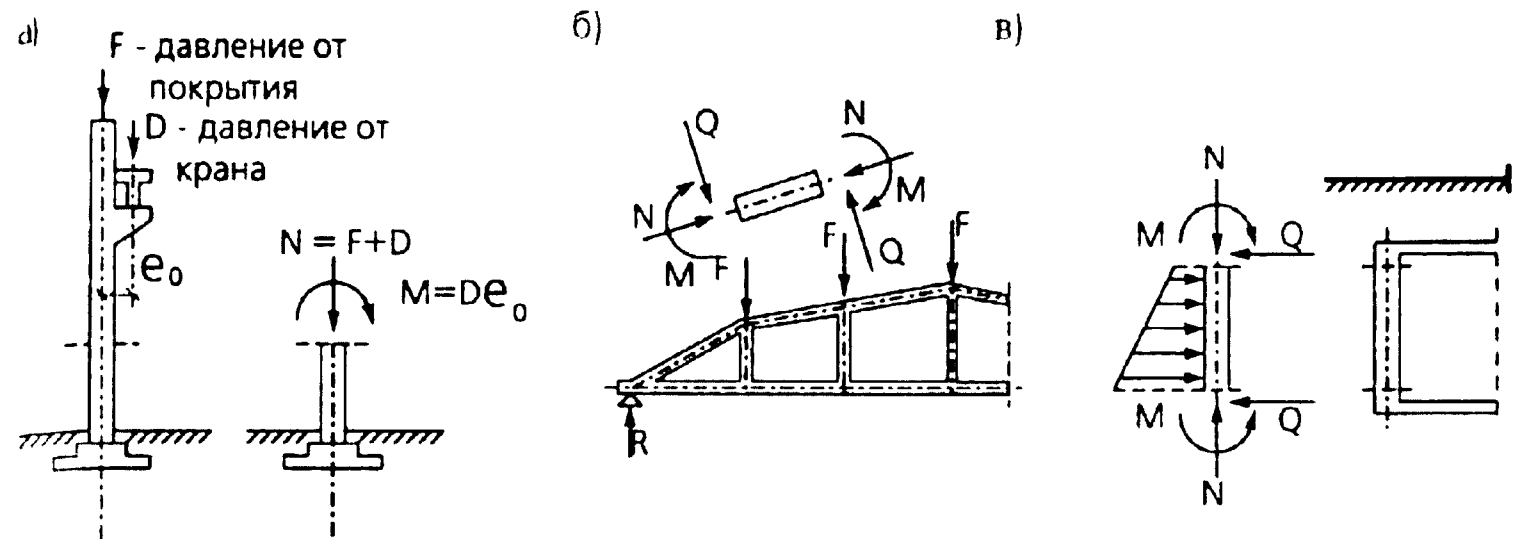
Внецентренно-сжатые элементы: а - колонна производственного здания; б - верхний пояс безраскосной фермы; в - стена подземного резервуара
